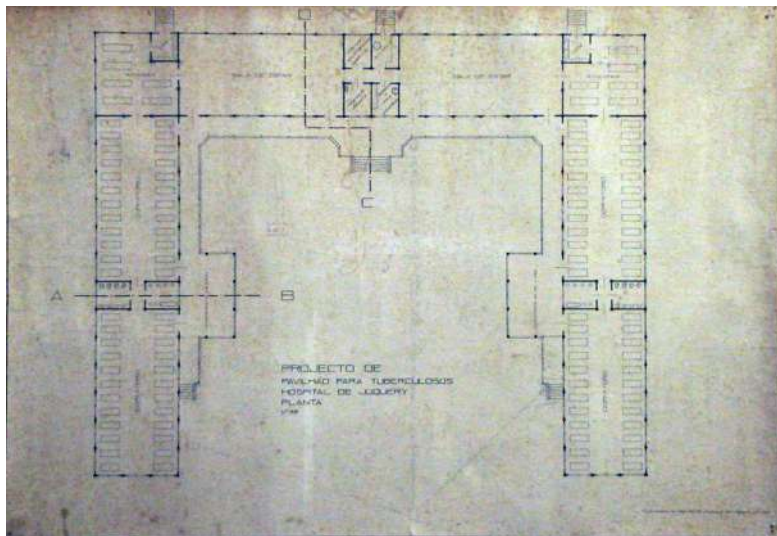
Cópia da planta original do Pavilhão de Tuberculosos (acervo Museu Osório César)
